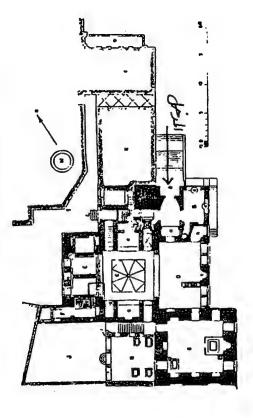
مسقط أفقى لمنشأة السلطان إينال عن محاضر لجنة حفظ الآثار
